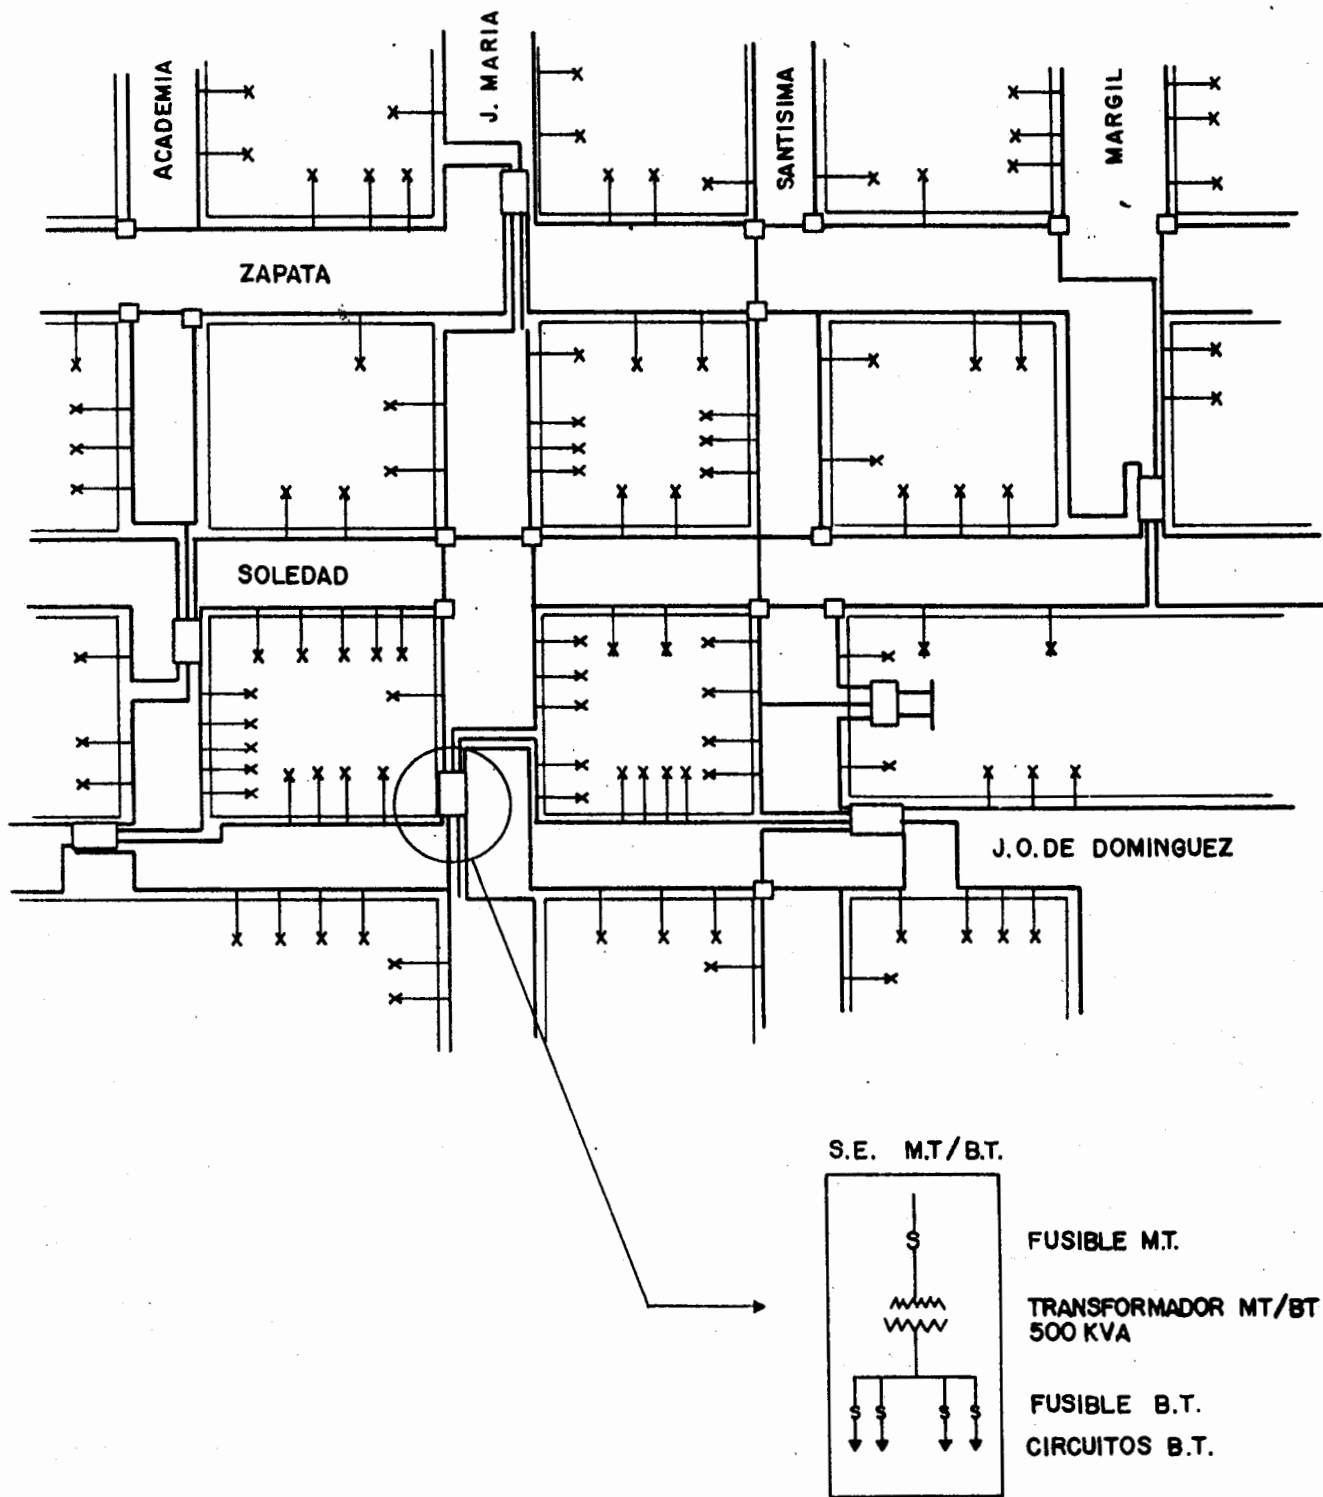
ESTRUCTURA DE BAJA TENSION CON SECCIONAMIENTO
